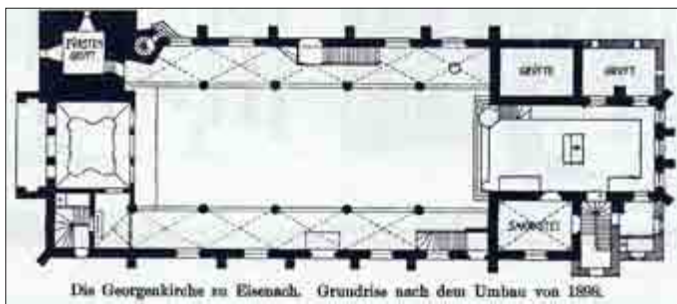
Grundriss Georgenkirche Eisenach, in: BDK Thüringen, Heft 39, S. 222
